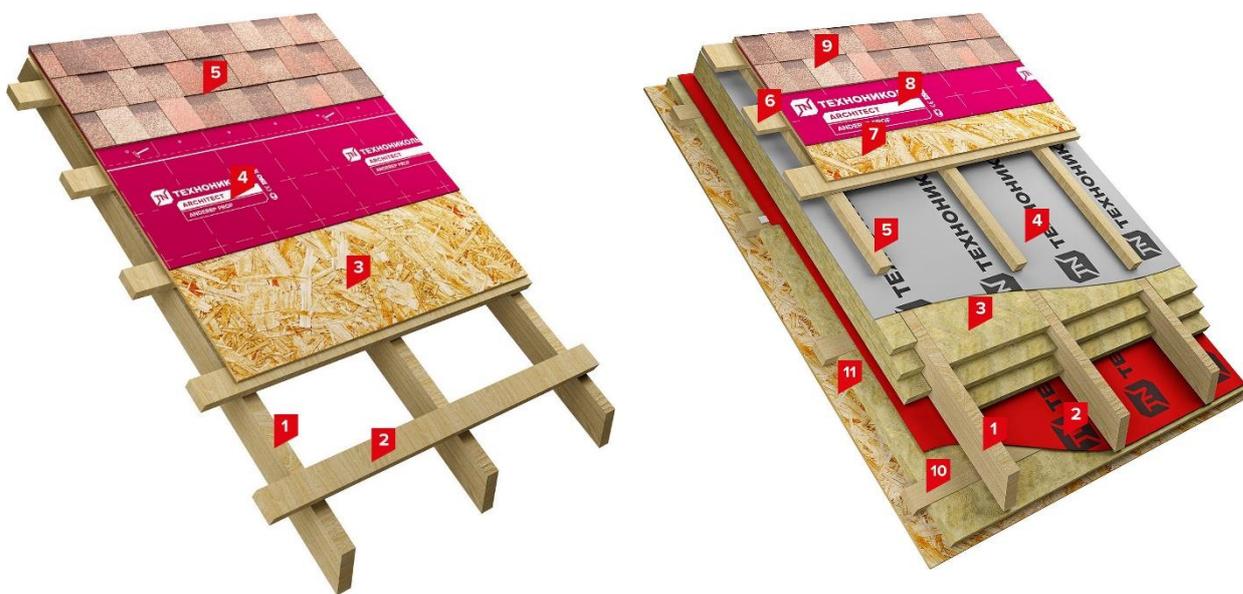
Возможные варианты устройства кровельного покрытия крыши с холодным чердаком (А) и утепленной мансарды (Б)
